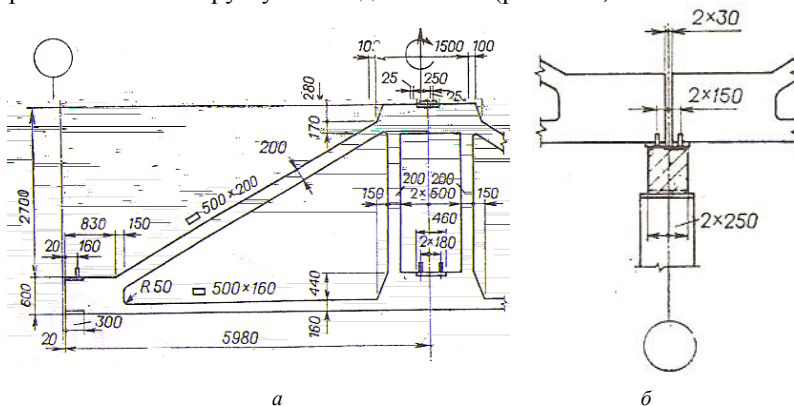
Подстропильная железобетонная ферма для малоуклонных покрытий:
